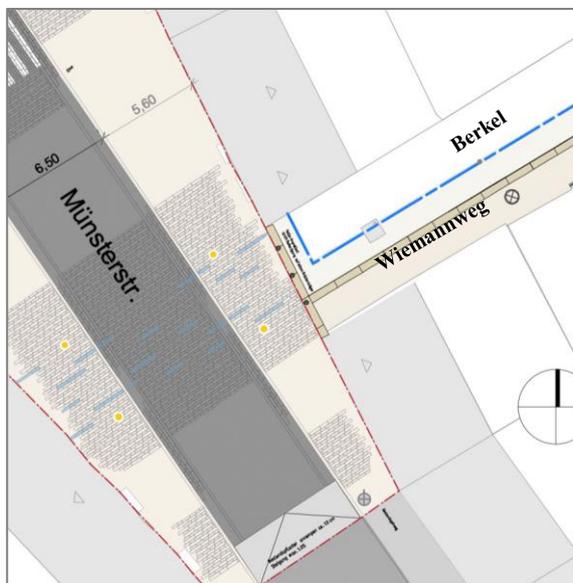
Teilbereich 4/5: Einmündung Münsterstraße
